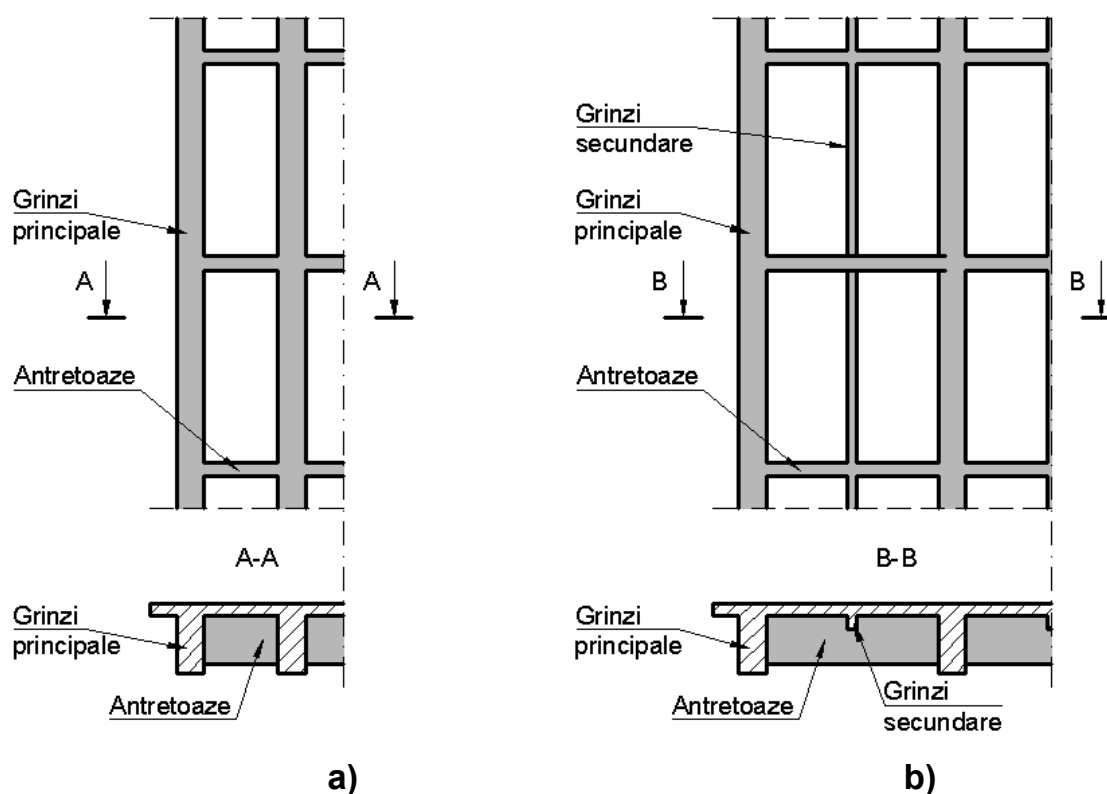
Scheme în plan ale podurilor cu grinzi din beton
